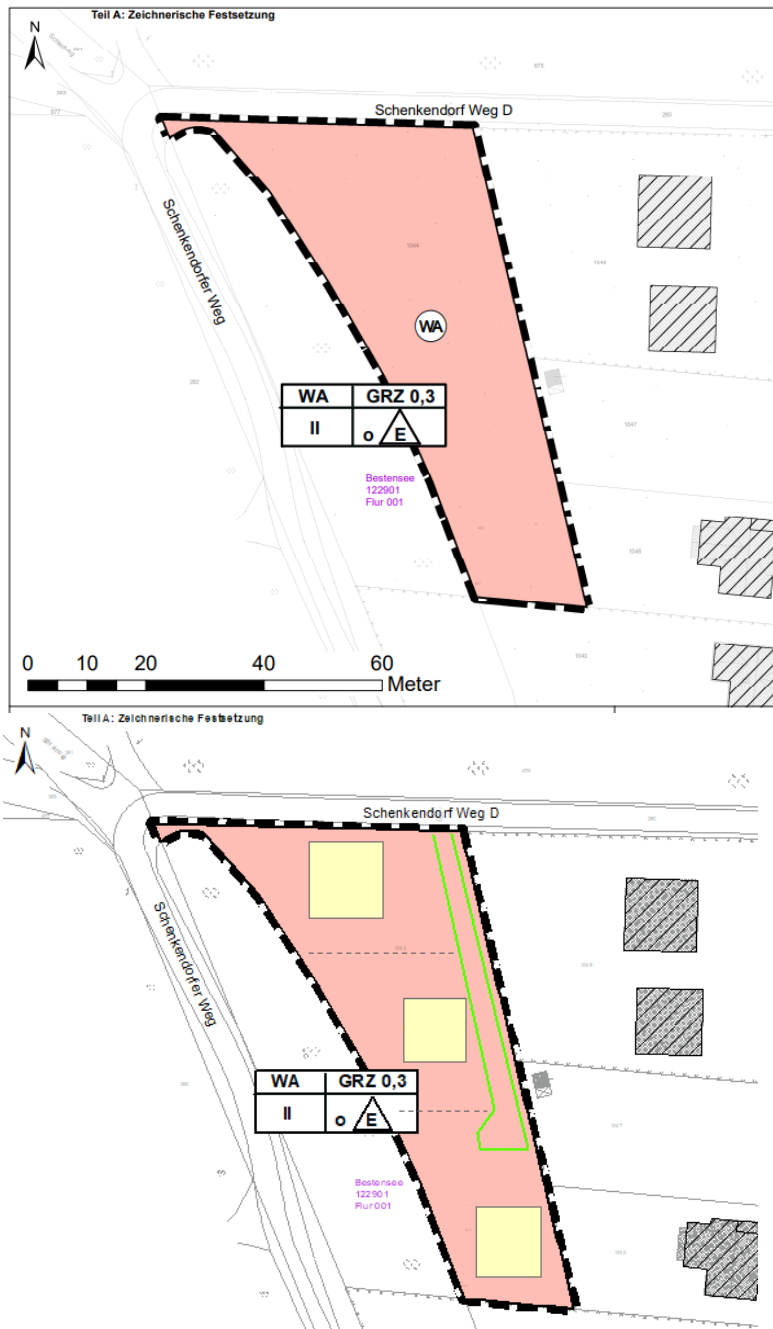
oben - Ausschnitt aus der Planzeichnung; unten Ausschnitt der Planzeichnung mit möglicher Parzellierung und Erschließung
